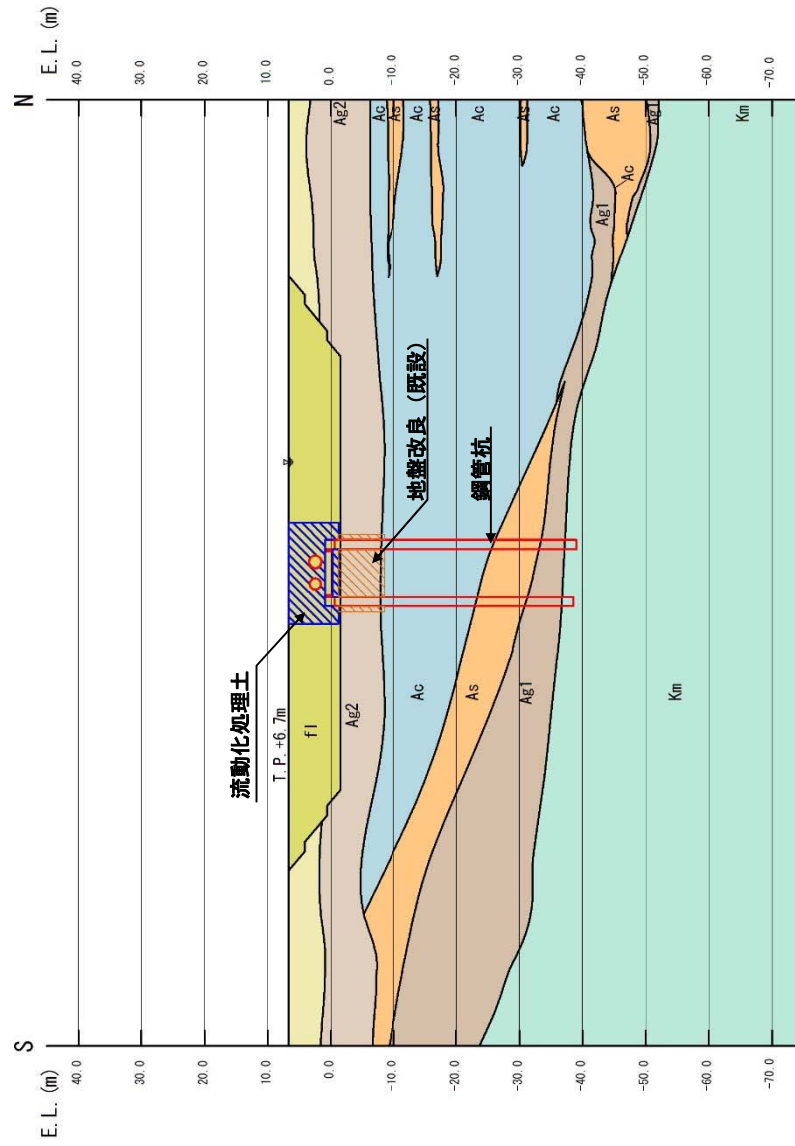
(2) 屋外二重管の横断面図 (B-B断面) (区間 I 断面①)
